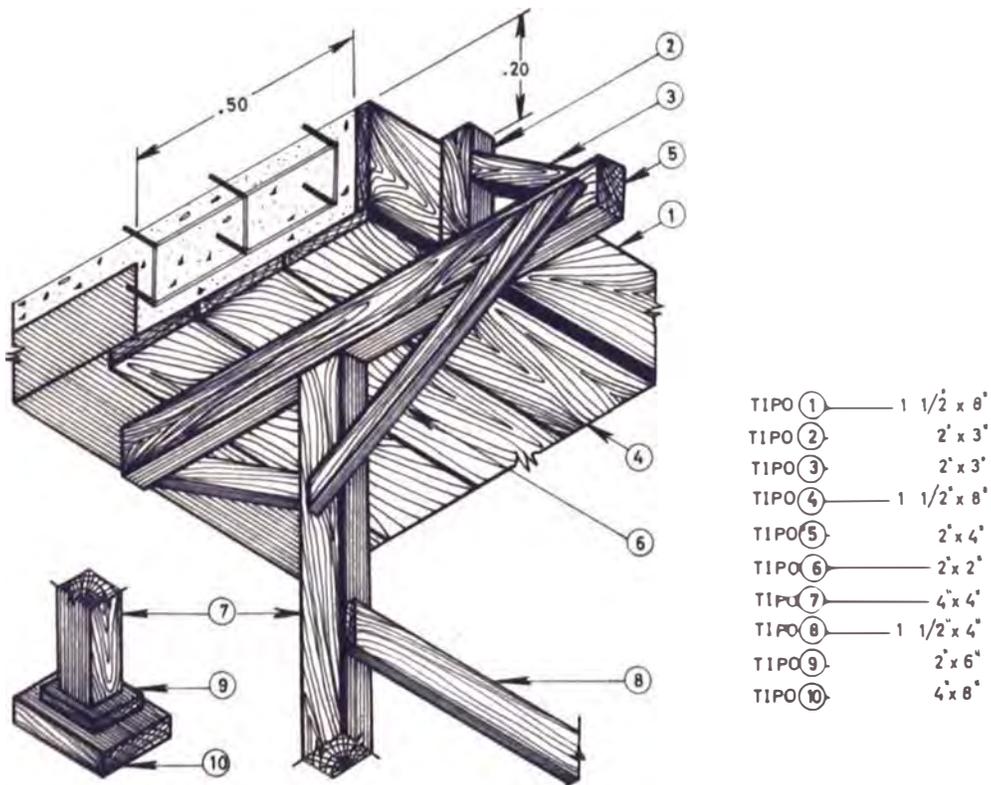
ENCOFRADO DE VIGA 1-V-5 CHATA EXTR. .50x.20m
